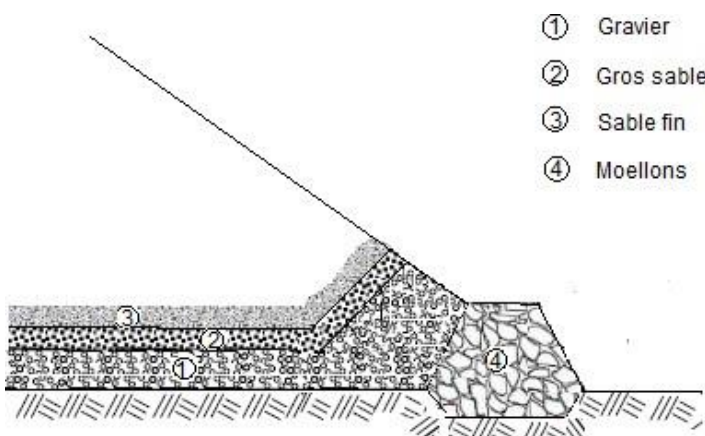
Disposition du drain et du filtre (fondation imperméable)
